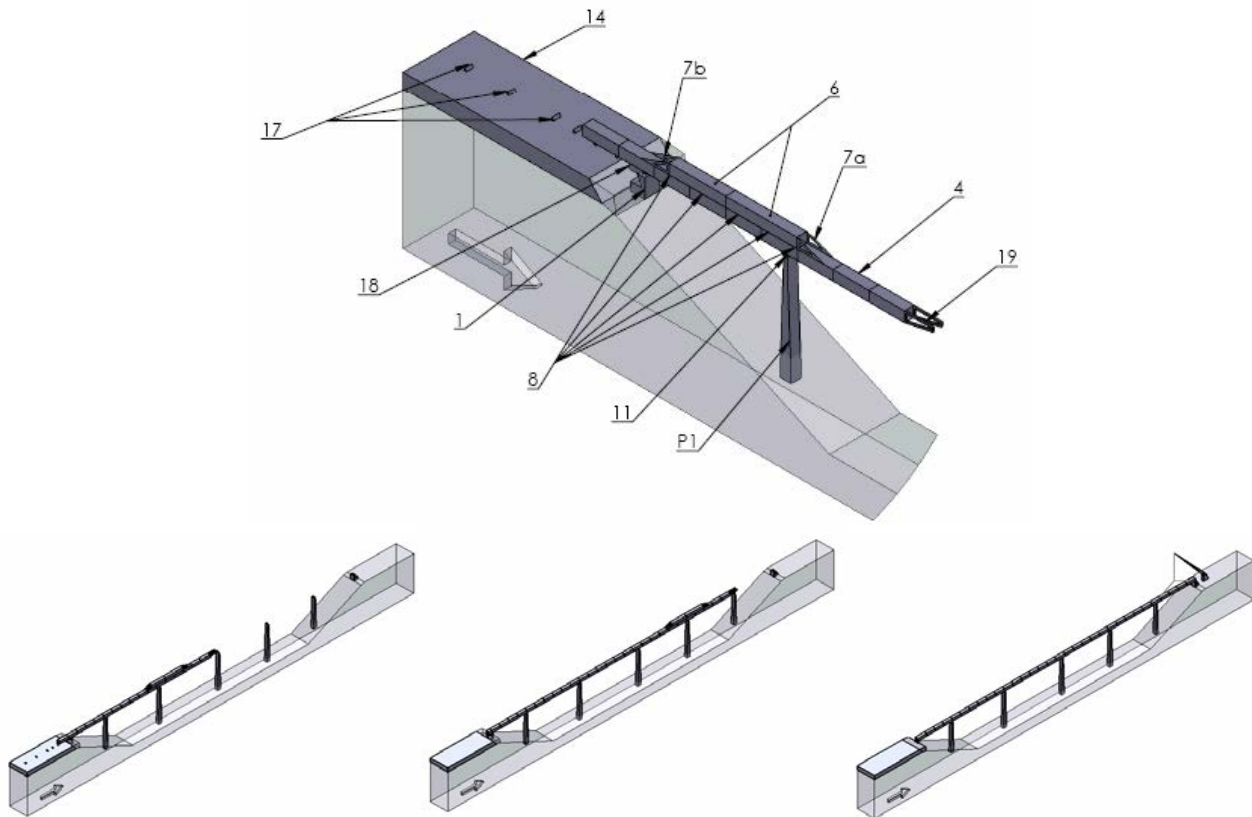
Detalles del sistema de lanzamiento (arriba) y secuencias del montaje (abajo)
